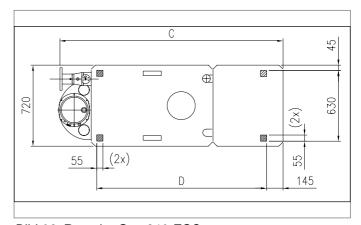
Remeha Gas 310 ECO 00.31H.79.00005
